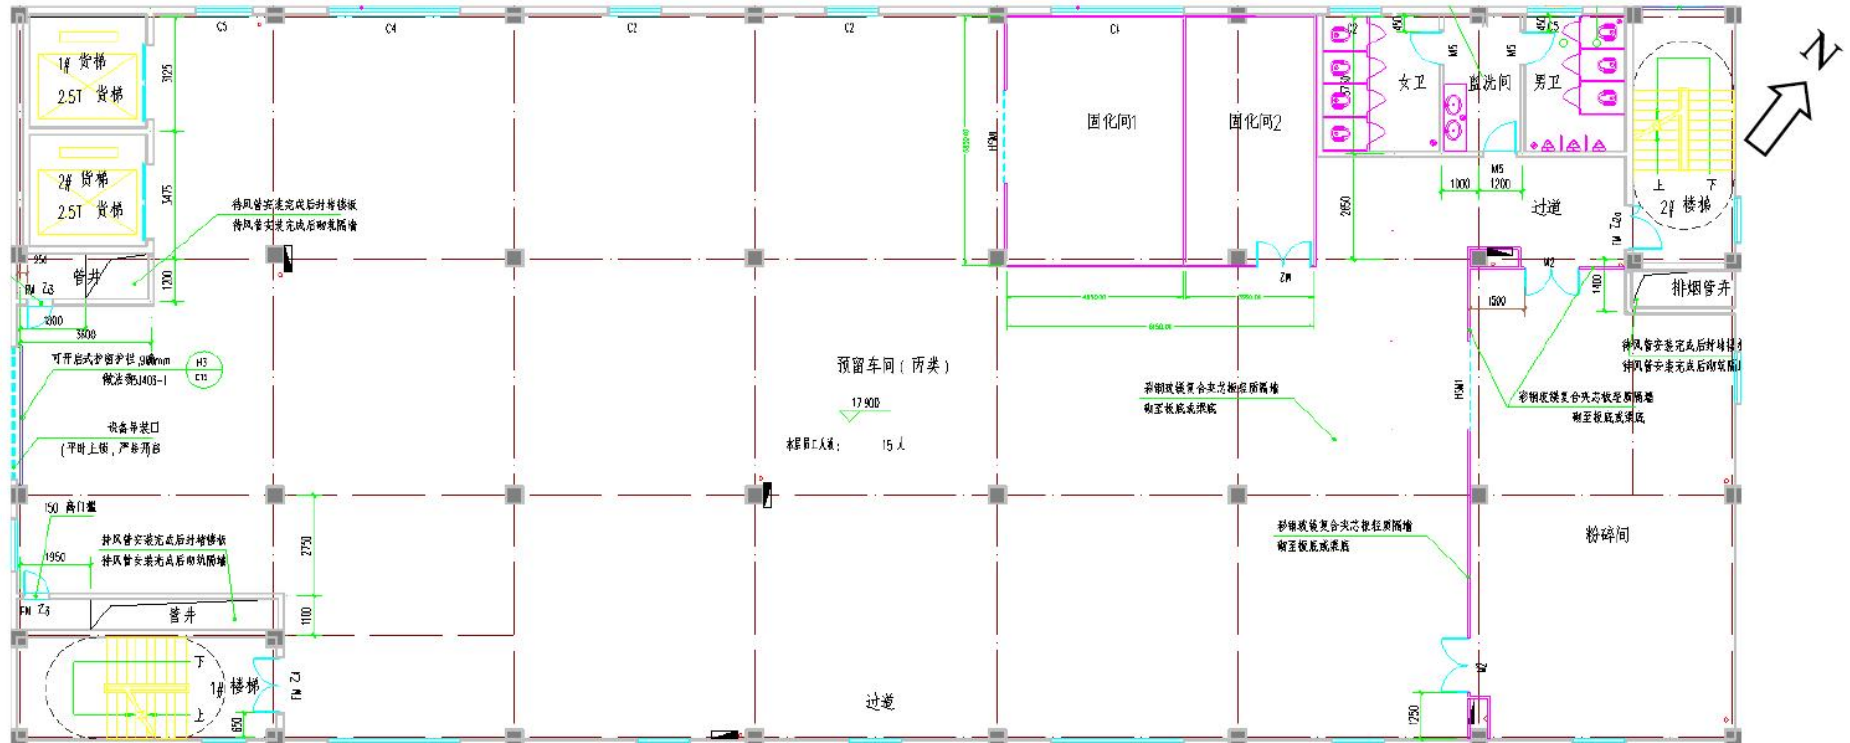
扩建项目平面布置图（丙类车间一层）
